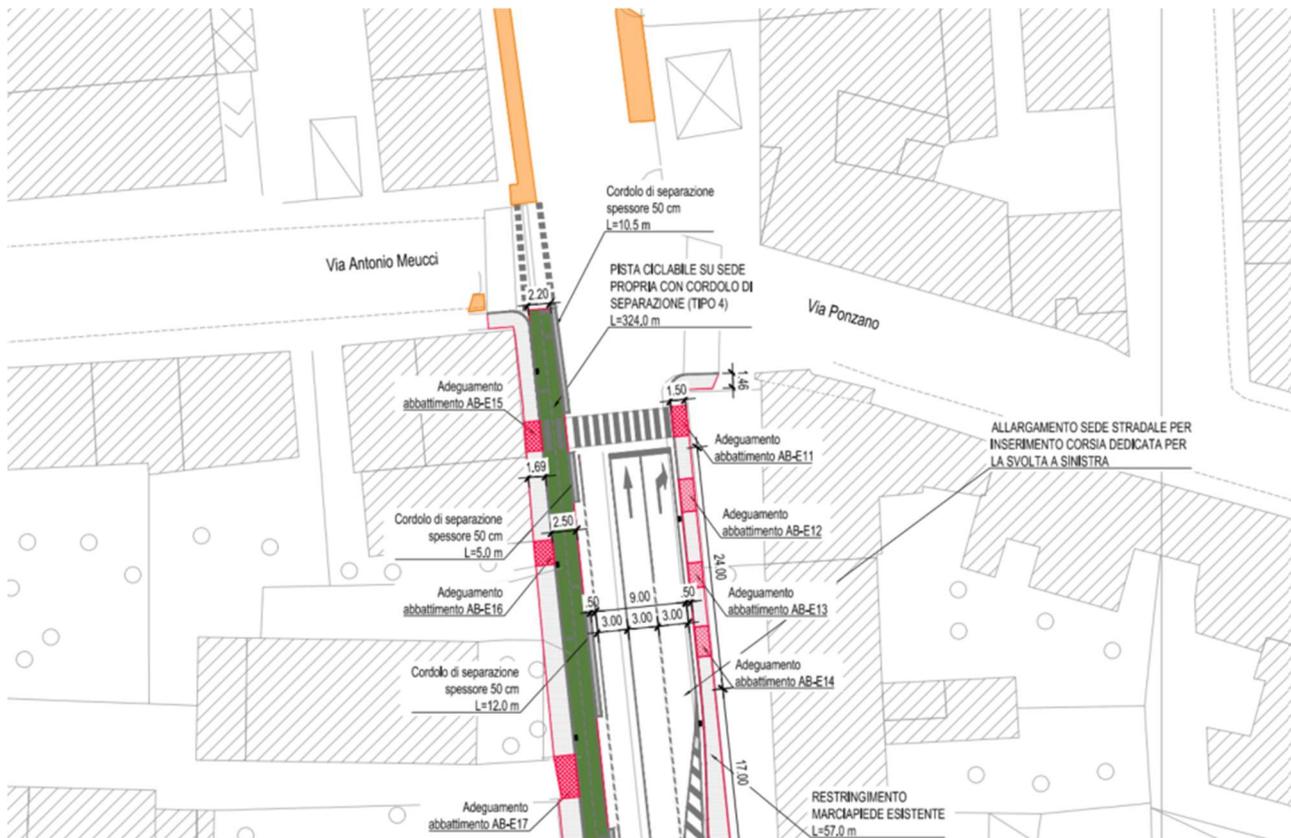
Estratto planimetria interventi WBS\_03 – primo tratto
